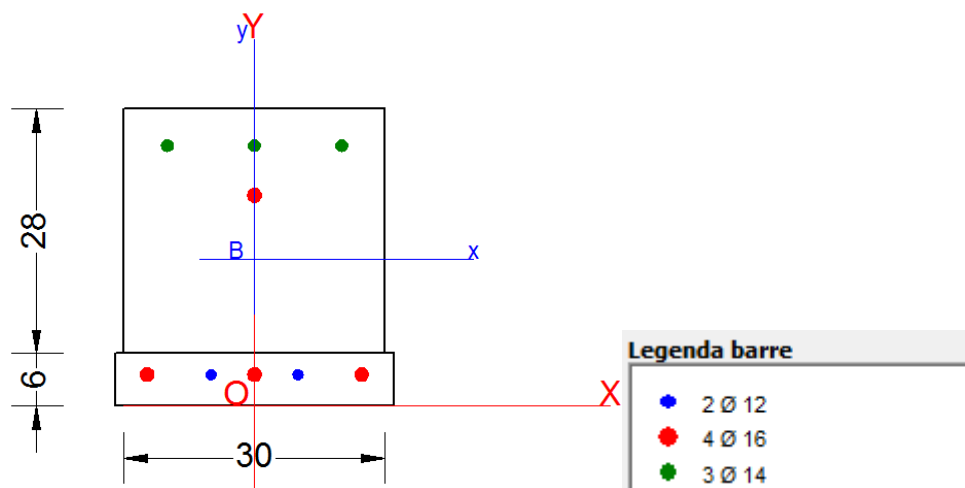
Schema di armatura nella sezione di seconda fase – appoggio
